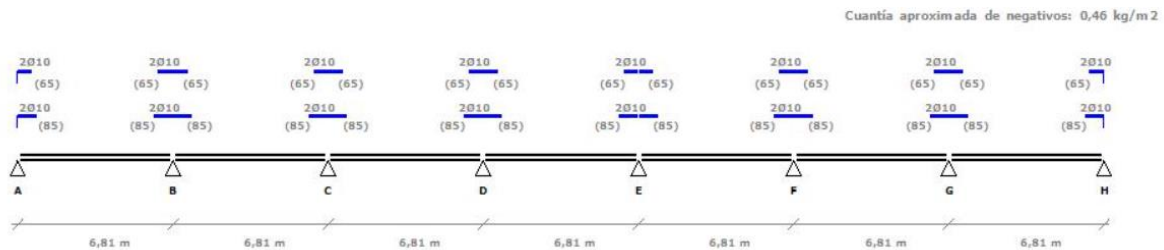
Armado de negativos, forjado de la primera planta. Fuente: AIDEPLA
